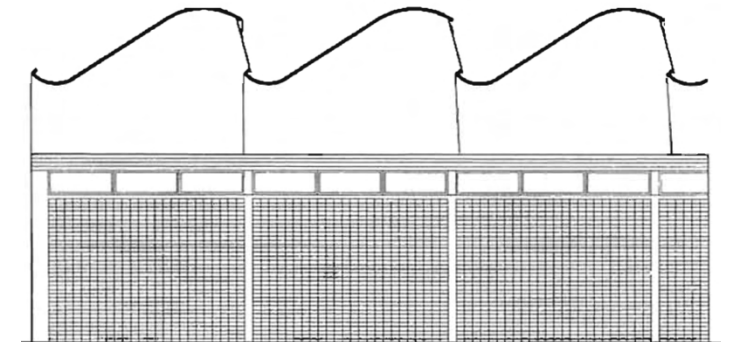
I Alzado bóveda gausa. Fuente: Dirección General de Arquitectura y Vivienda
